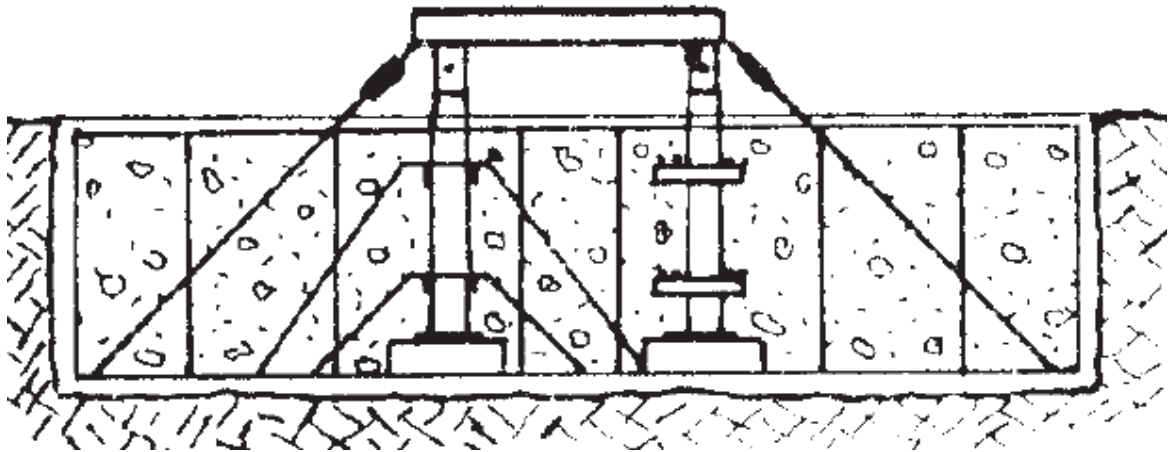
Detalle de pies de empotramiento en el hormigón con forjado y la utilizando la plantilla para su correcta nivelación.
